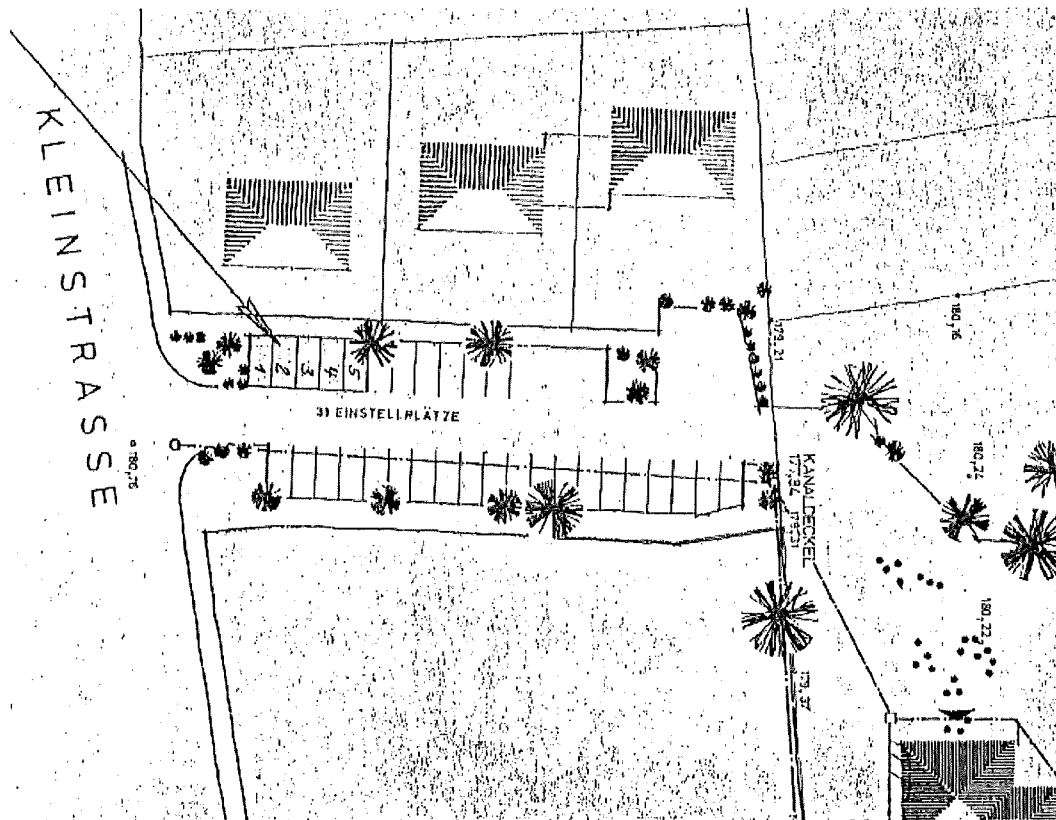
Lageplan als Anlage des Vertrages von 1973
